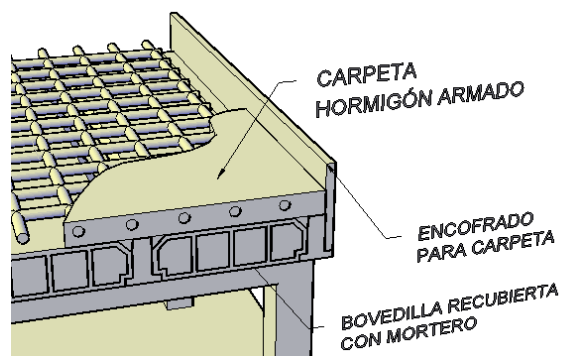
Detalle de colado de la carpeta de hormigón armado.
